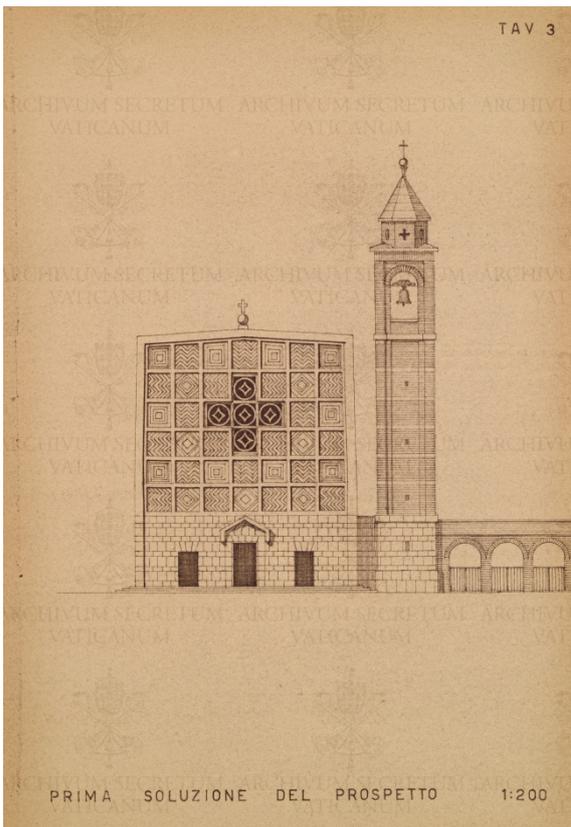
1953 - soluz. B - Tav. 3, prospetto della chiesa (ASV)
